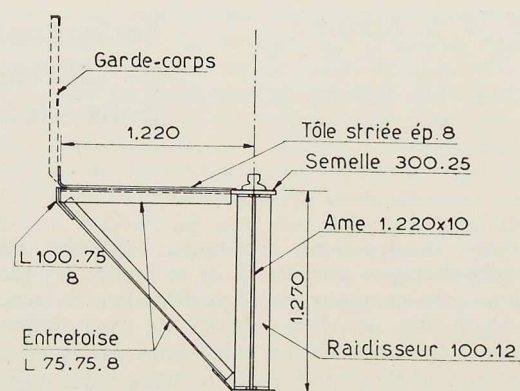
Abbey Works. Détail des poutres de roulement. Ces poutres ont une section triangulaire en caisson.
